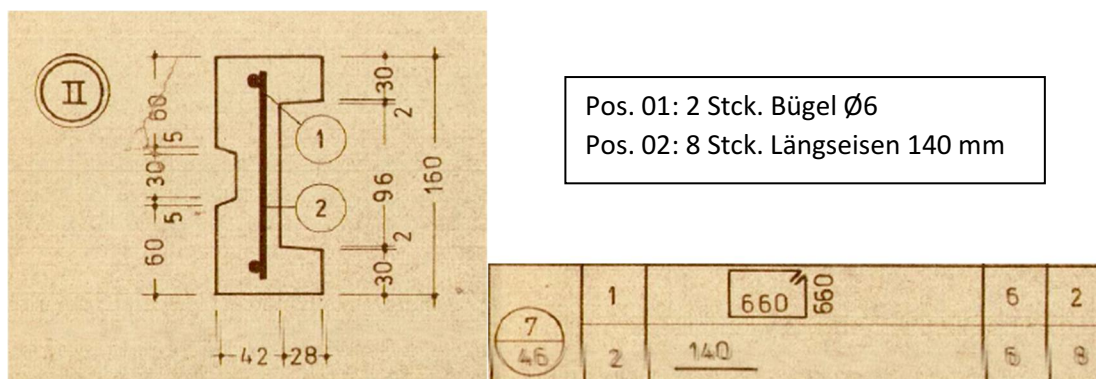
Bewehrungsplan Rahmenelement Bestand
